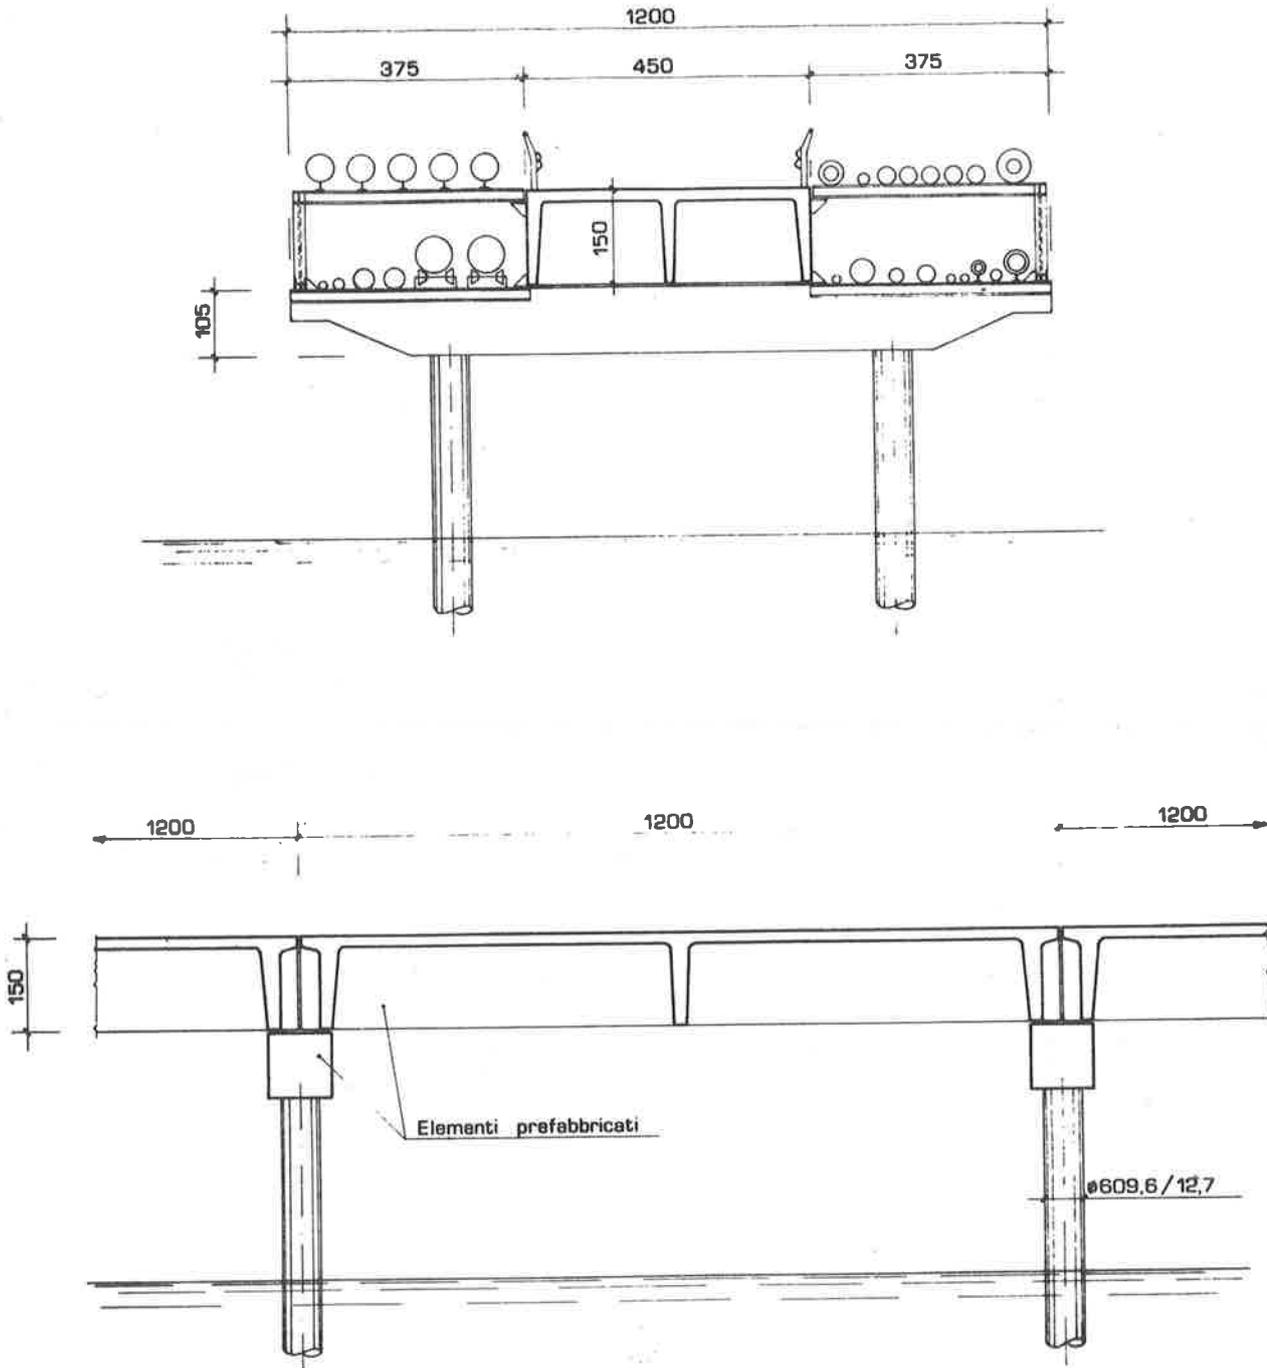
Pontile RUMIANCA - Sezioni dell'impalcato
